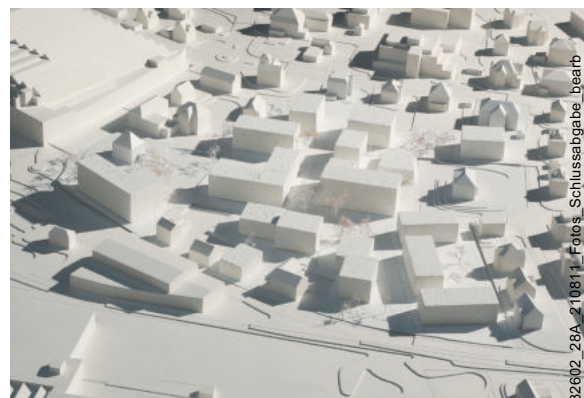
Modellfoto West-Ansicht, Team camponovo baumgartner architekten
